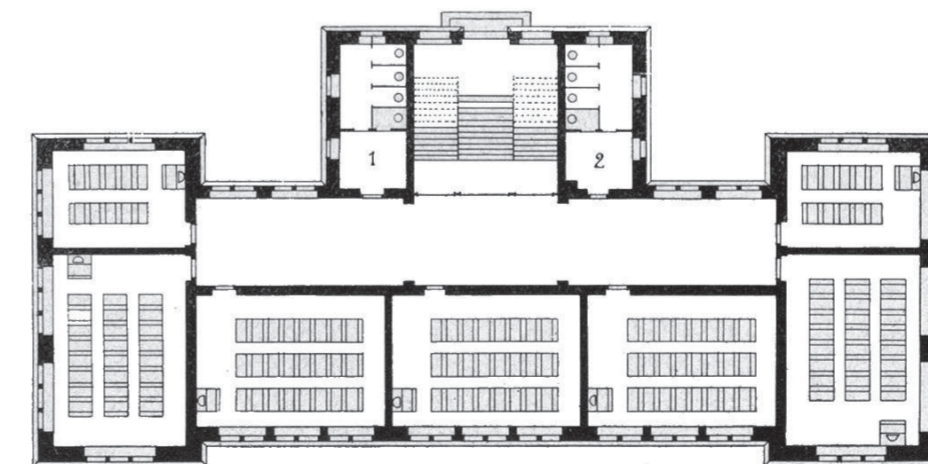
Planta de escola no Modelo Prussiano, Europa Central, século XIX
